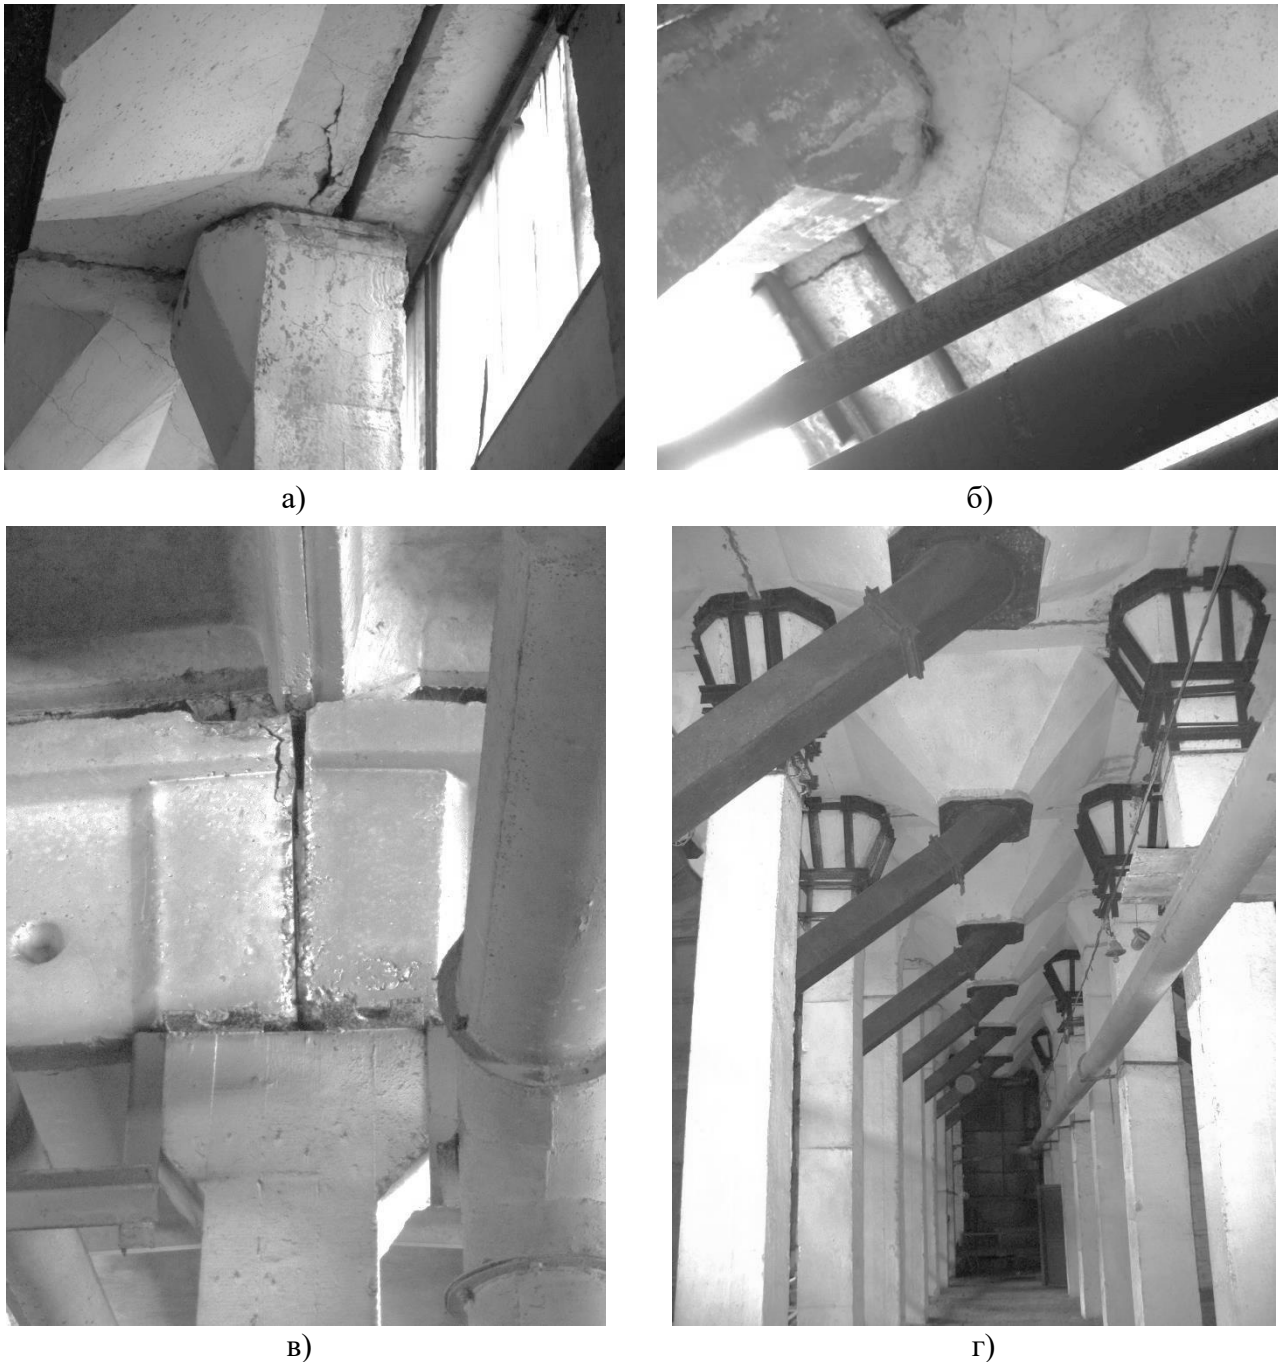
Деформації, дефекти та пошкодження будівлі елеватора силосного типу: а – руйнування об'ємного блоку силосного об'єму; б – руйнування стінової панелі силосного блоку; в – руйнування опорної ділянки збірної залізобетонної балки покриття завантажувального поверху; г – загальний вигляд галереї розвантажувального поверху до реконструкції
